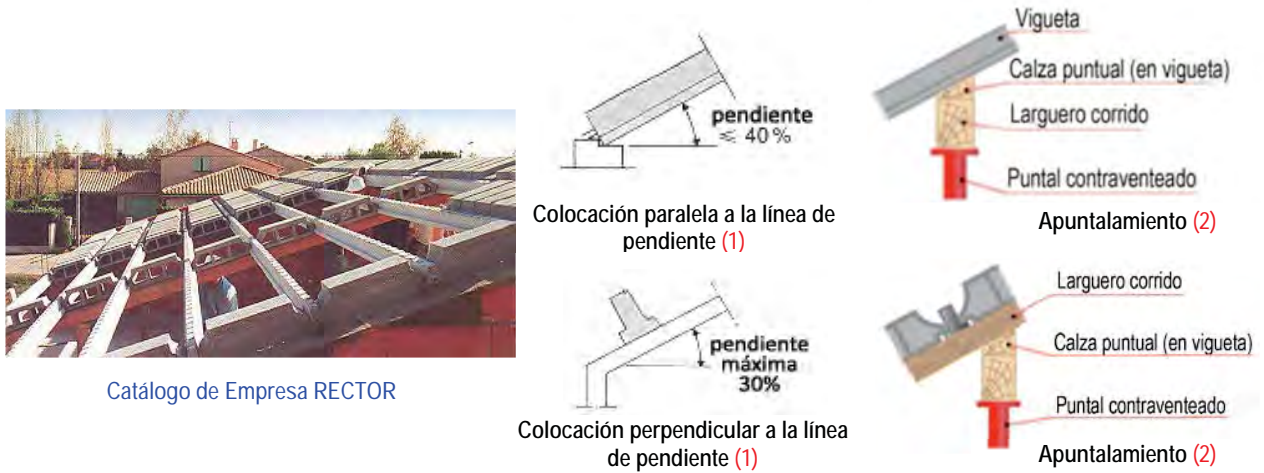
REQUISITOS DE EMPLEO DE VIGUETAS PRESFORZADAS EN CUBIERTAS INCLINADAS
